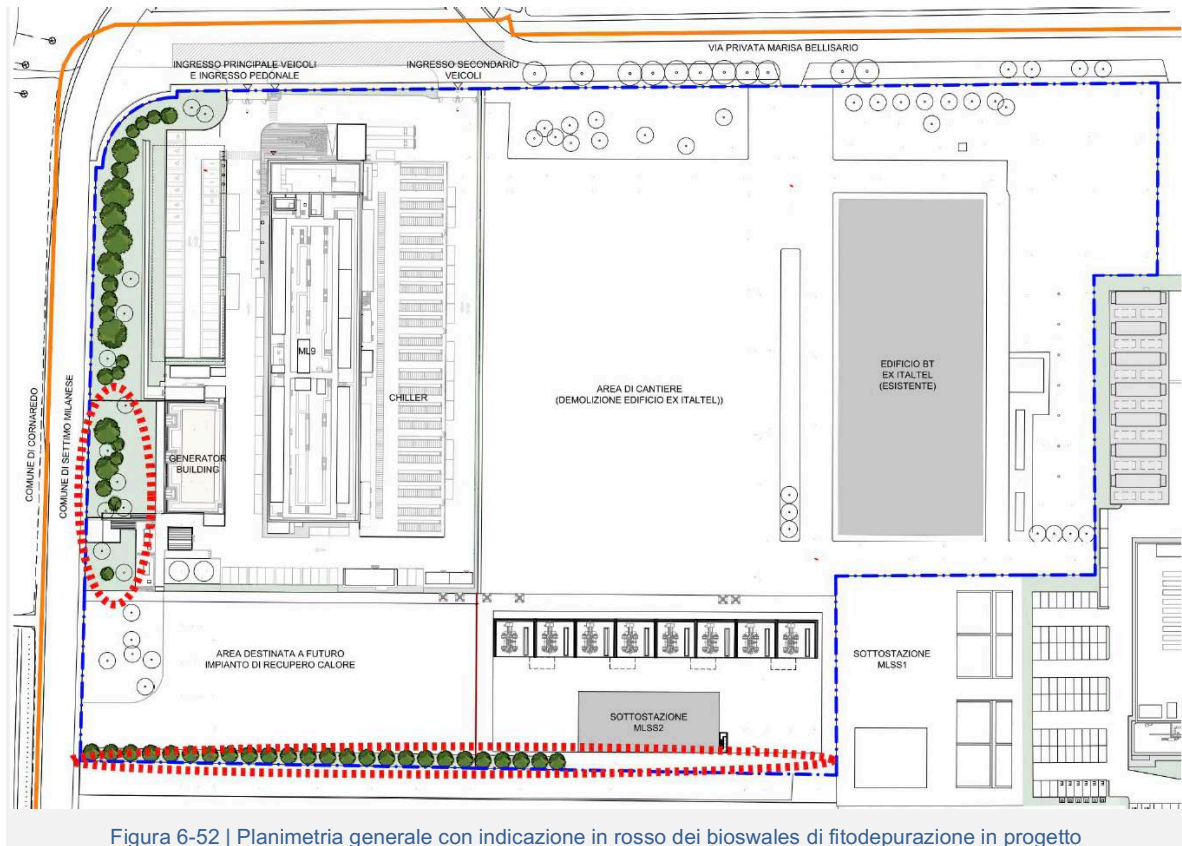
| Planimetria generale con indicazione in rosso dei bioswales di fitodepurazione in progetto
